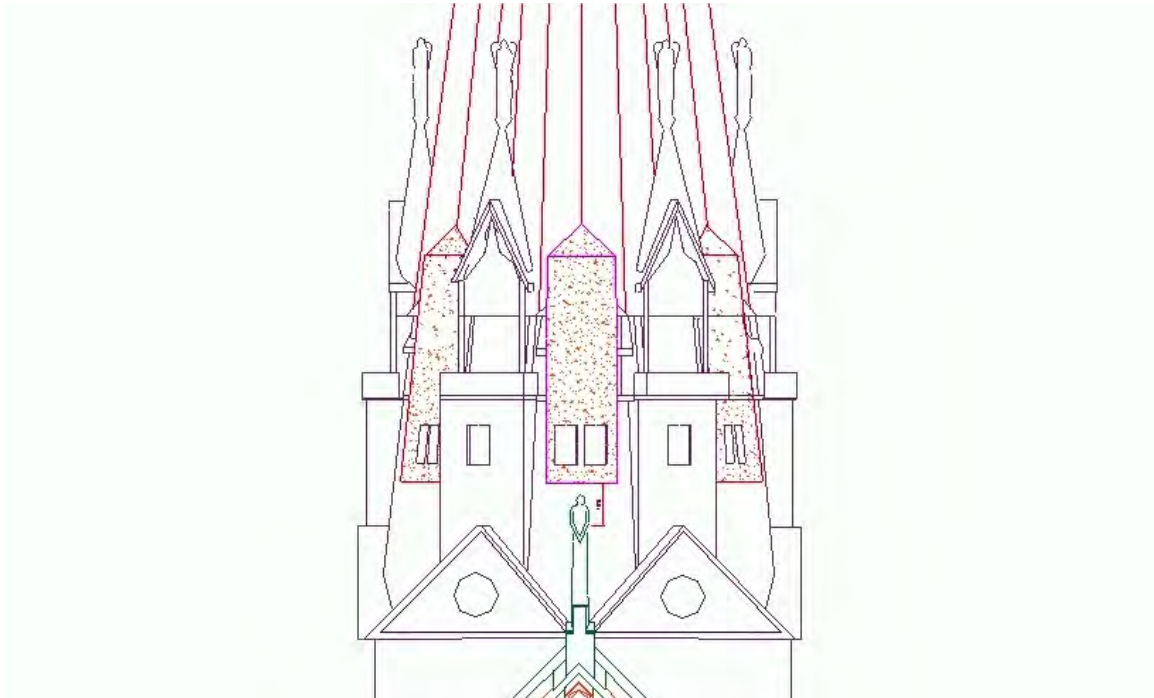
Detalle de pantallas de refuerzo adosadas en la aguja central
